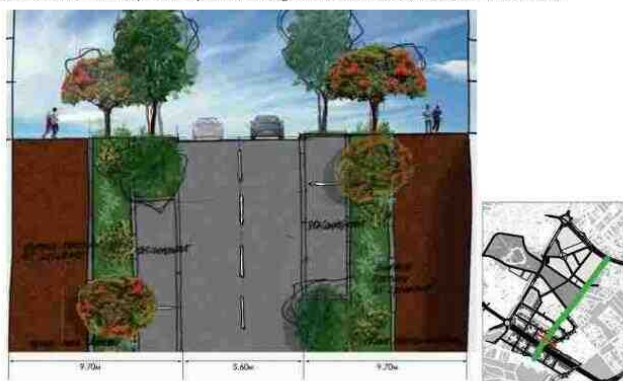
Profil en travers proposé au droit de la future voie structurante
